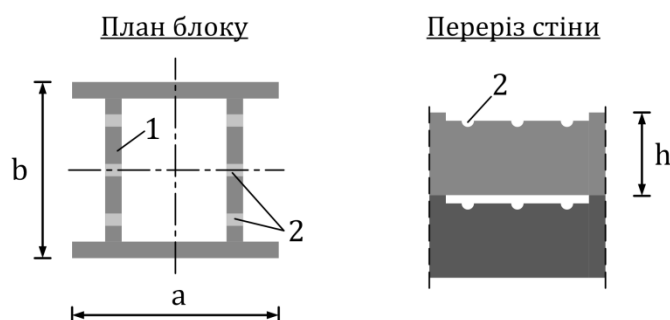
Габаритні розміри та елементи блоку БНО: 1 – бетонна перегородка; 2 – отвори для арматури.
